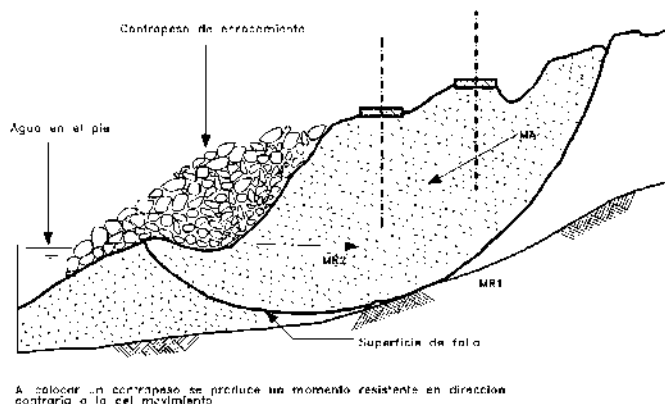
Contrapeso para la estabilización de un deslizamiento activo.
